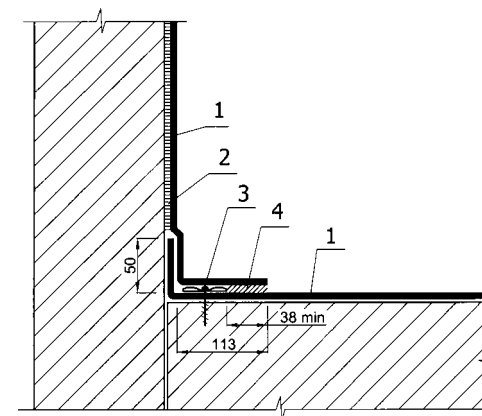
Примыкание кровли к парапету, стене (Вариант 2)
